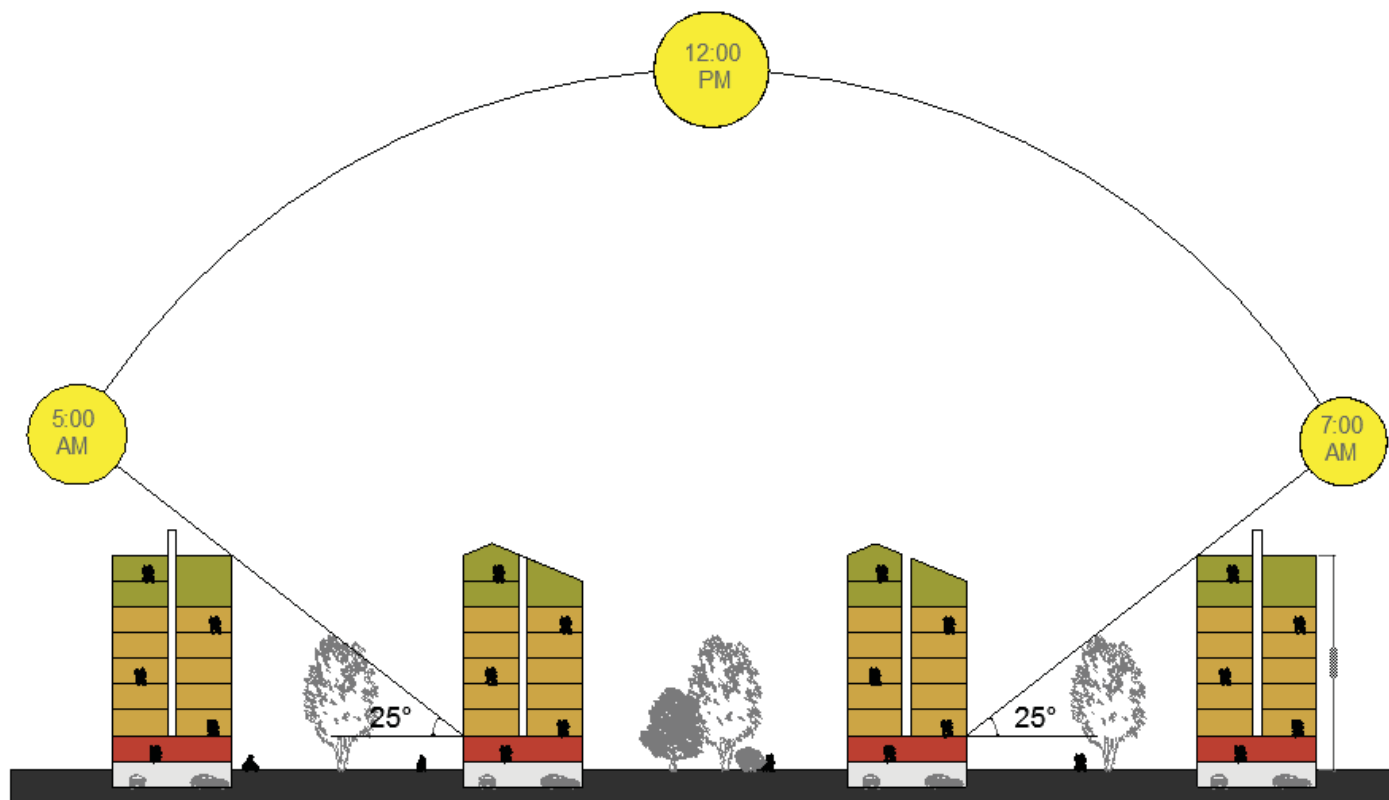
Angulo de inclinacion para el asoleamiento y la iluminacion en los bloques de viviendas
